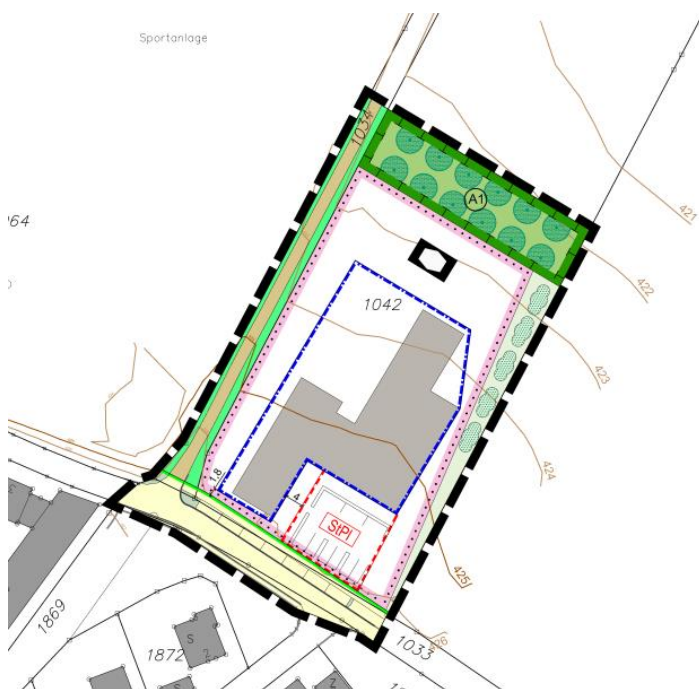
Ursprungsbebauungsplan, Ausschnitt aus der Planzeichnung⁴
